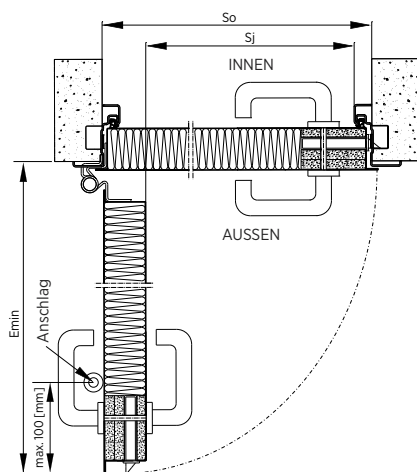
Montage in der Eckzarge - Horizontalschnitt
